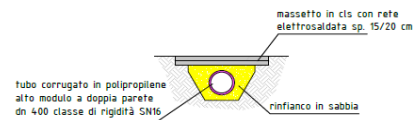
tipologia di attraversamento stradale e cavalcafosso in progetto.
